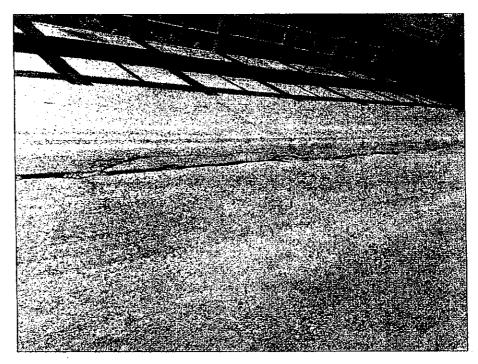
Vista superior evidenciando trinca no pavimento na região da junta longitudinal das obras.
